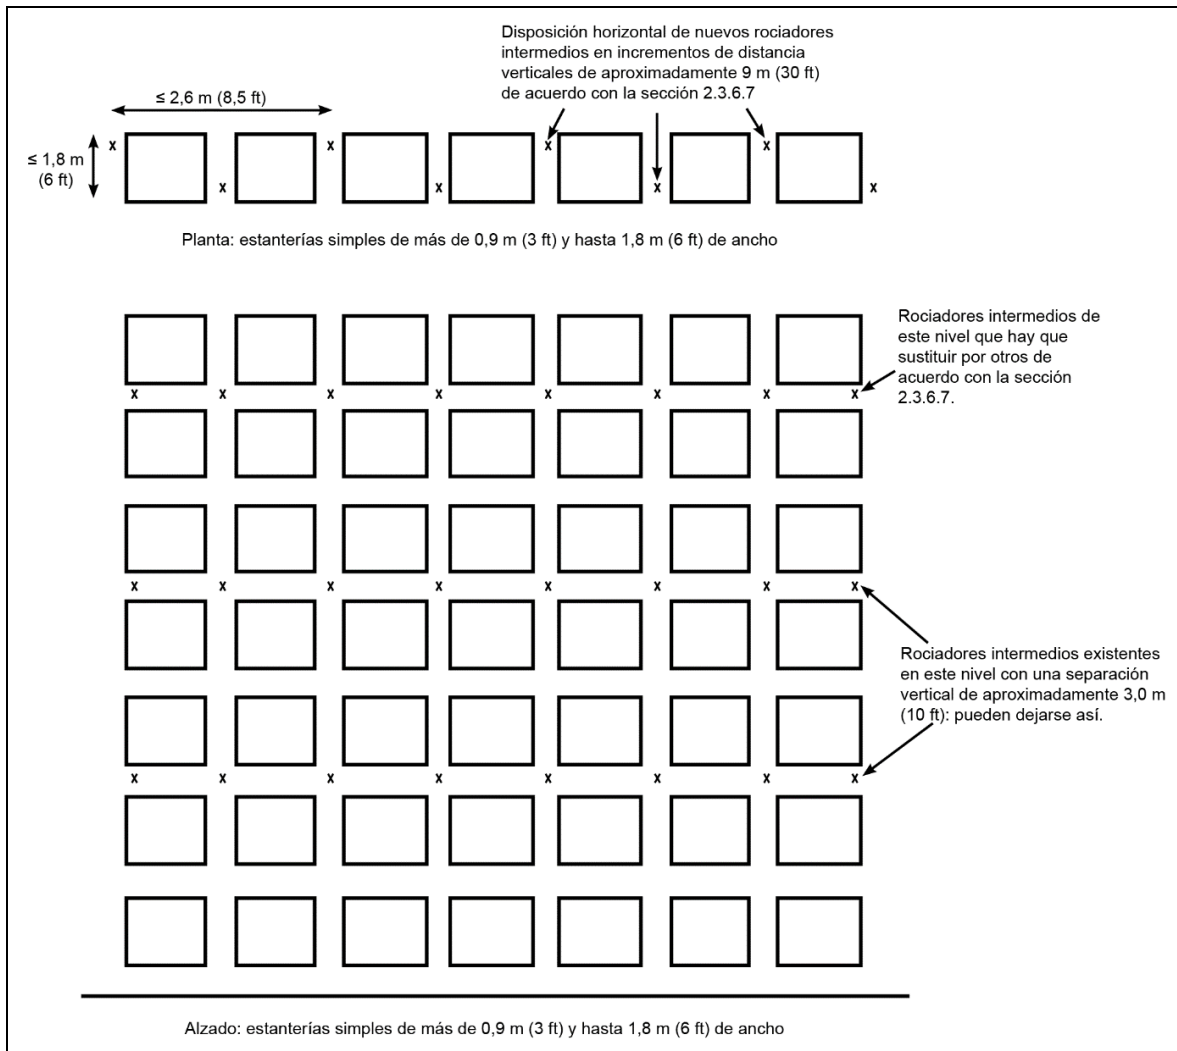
Protección de mercancías de plástico sin embalaje de cartón en estanterías abiertas simples desde 0,9 m (3 ft) hasta 1,8 m (6 ft) de ancho
